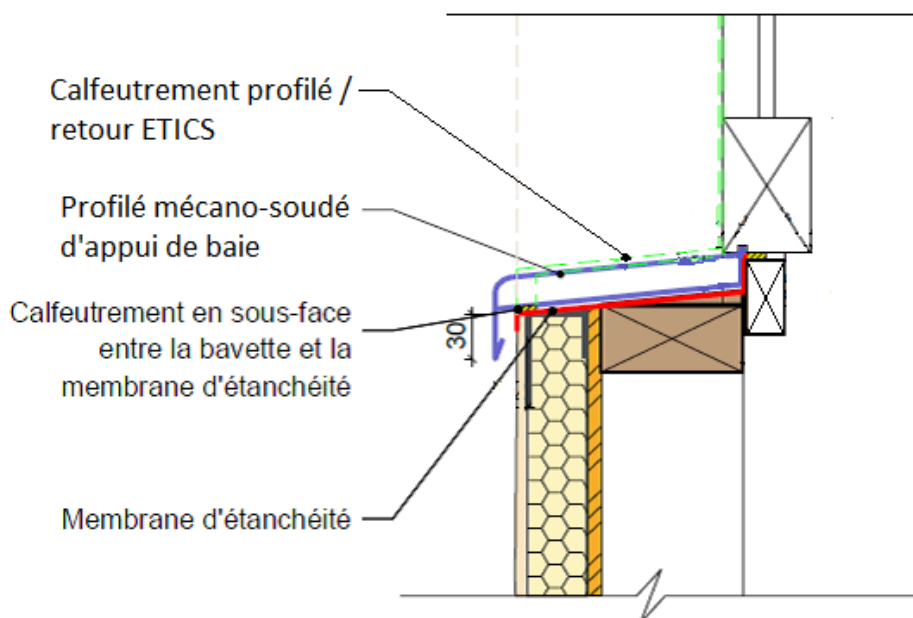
Retour d'enduit en tableau (Ee1) – coupe verticale sur appui
